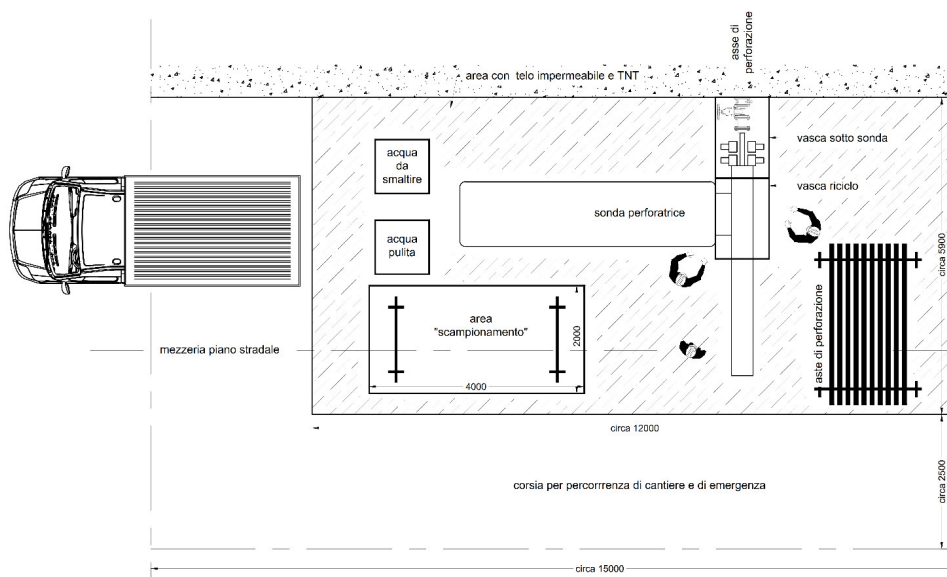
schema di cantierizzazione sonda all'interno del traforo
